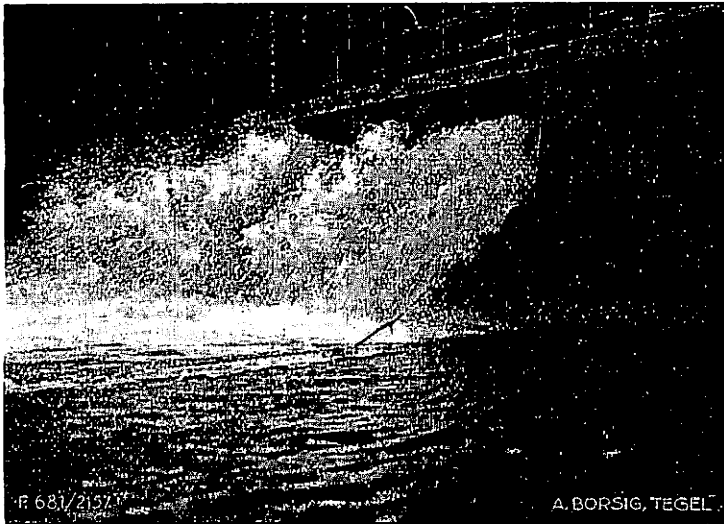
Mammutpumpen-Ausguß beim Bau der Spree-Unterfahrung Inselbrücke.
